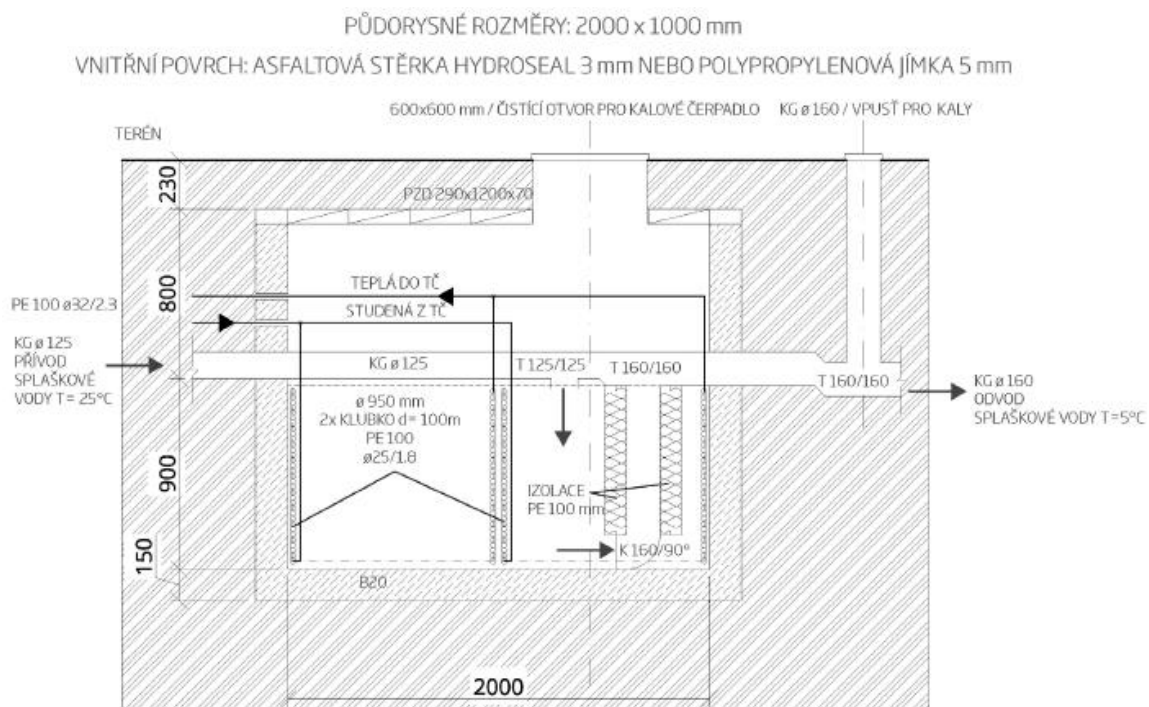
Provedení výměníku v jímce dle Ing. Červína [34]
